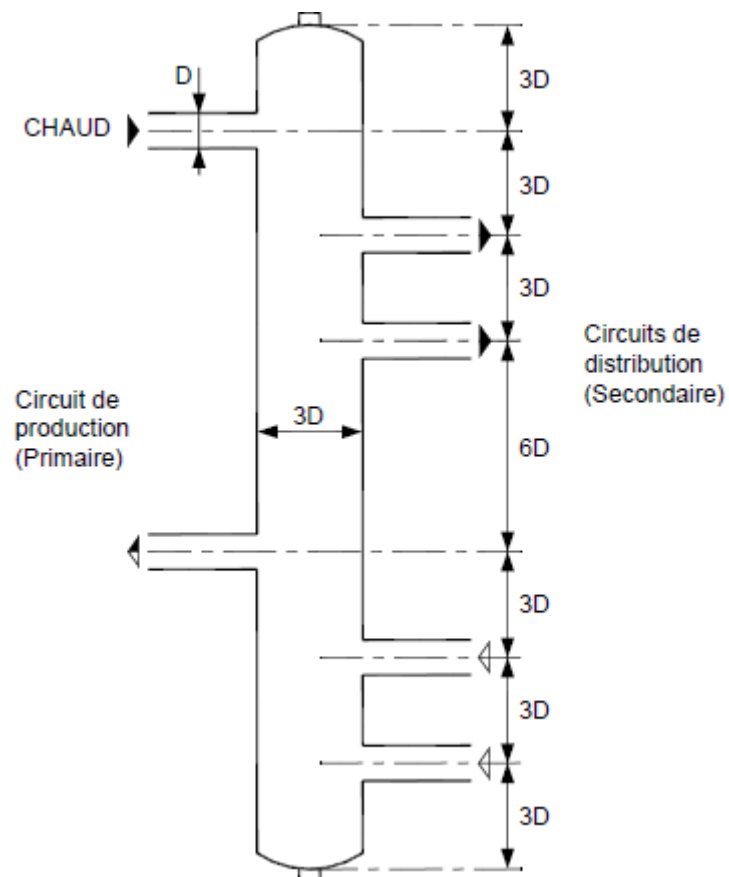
Bouteille de découplage dimensionnée selon la règle des 3D
